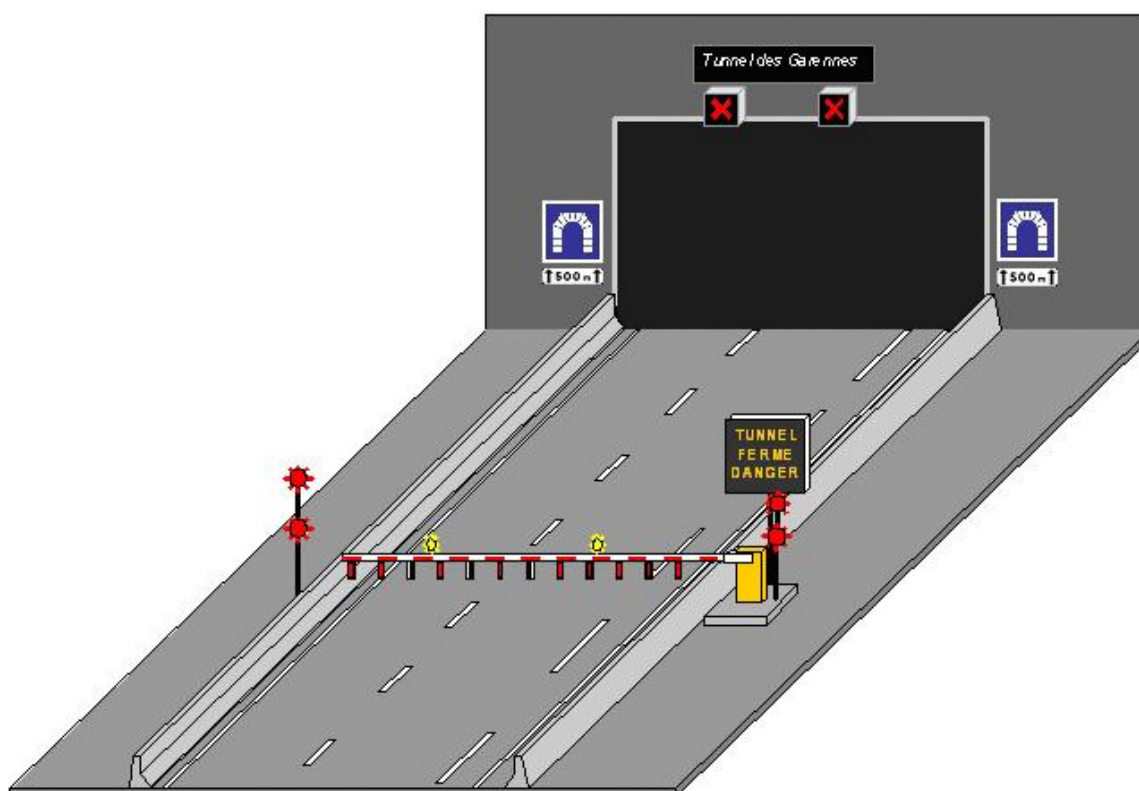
Exemple schématique de DFP en entrée de section courante de tunnel
